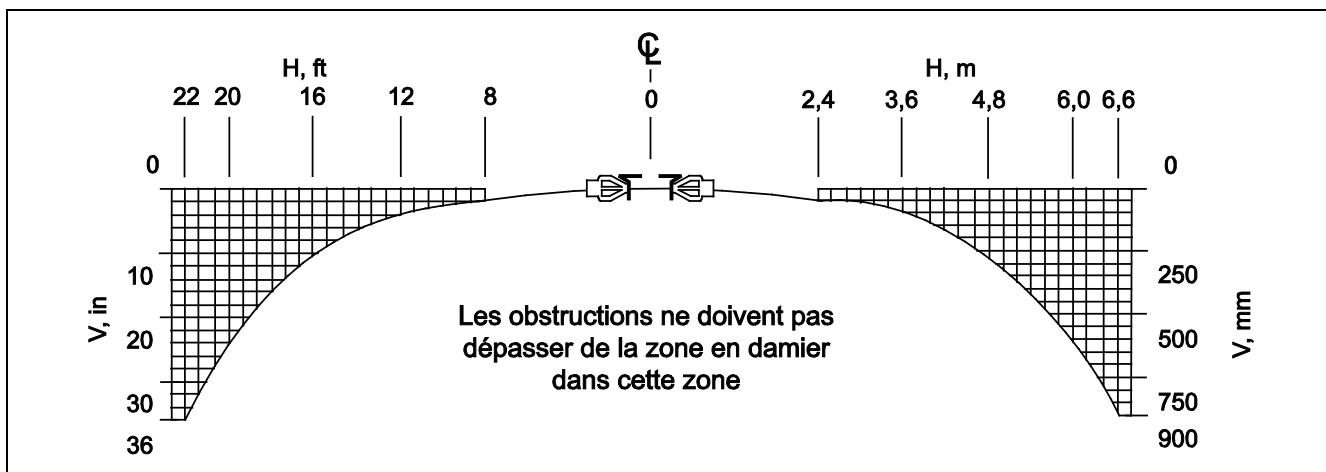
Zone d'obstruction au profil de distribution face aux sprinkleurs hors stockage muraux à couverture étendue.
